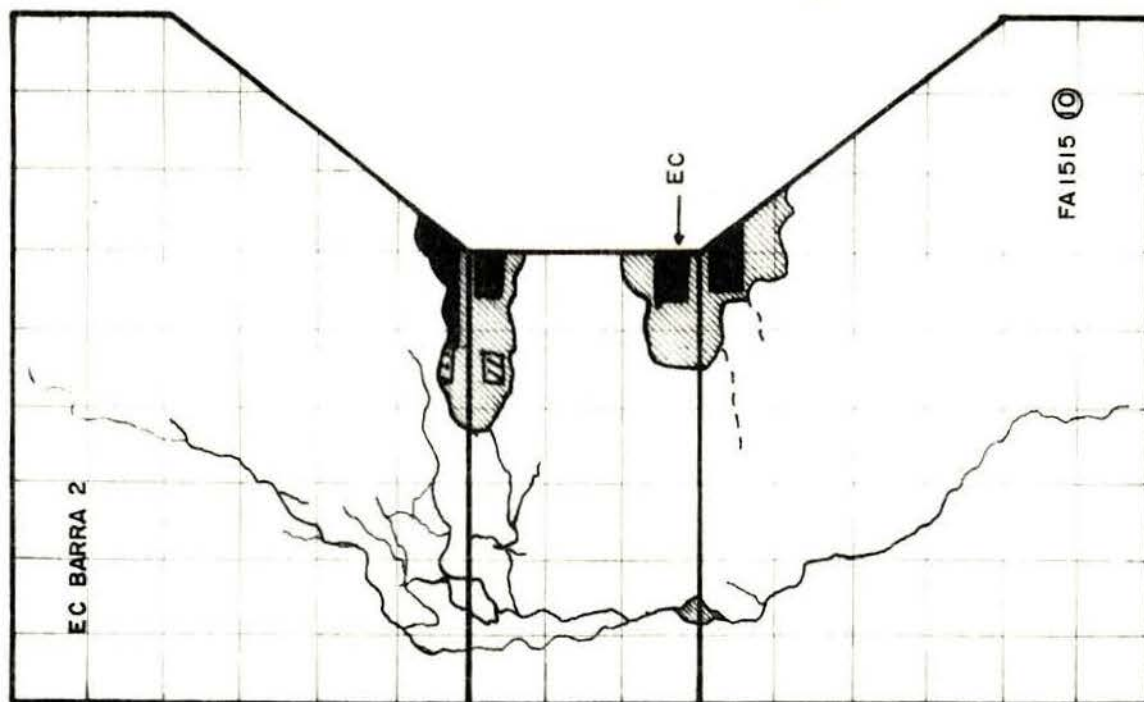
Fissuração dos CP FA1515
